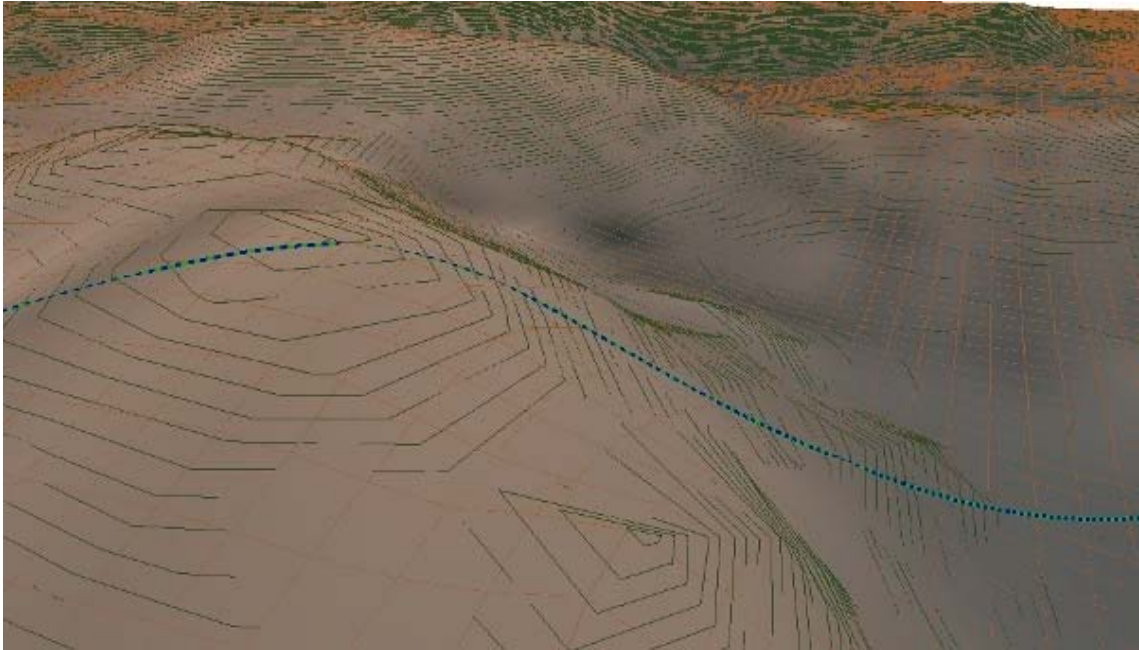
Configuração final apoiada – visão da descida do planalto – duto 16”
